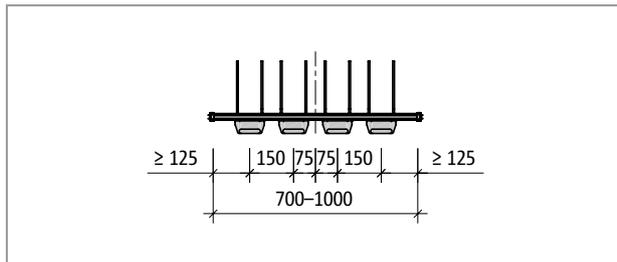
Schöck Tronsole® Typ T-V4-...-L700 bis L1000: Produktgrundriss
